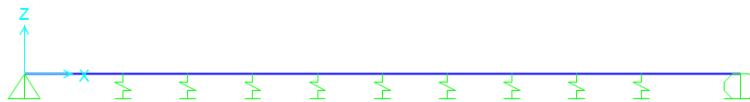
Modelo de cálculo para la escalera, solera y base de ascensor.
